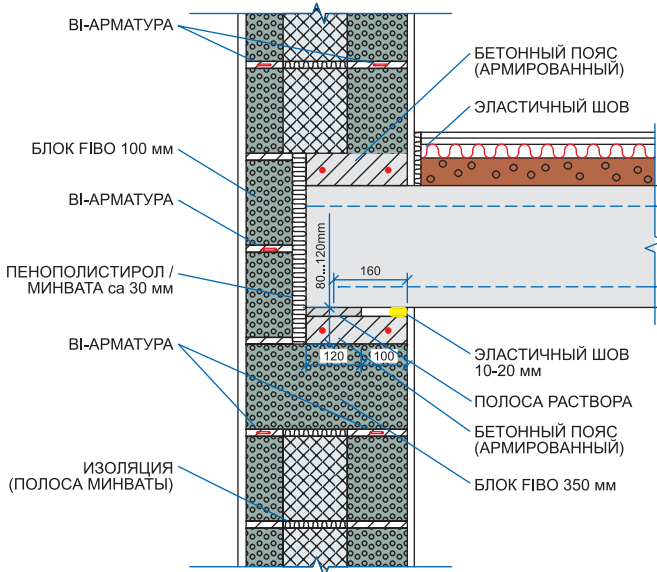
Опора монолитного перекрытия на кладку из FiboTerm
